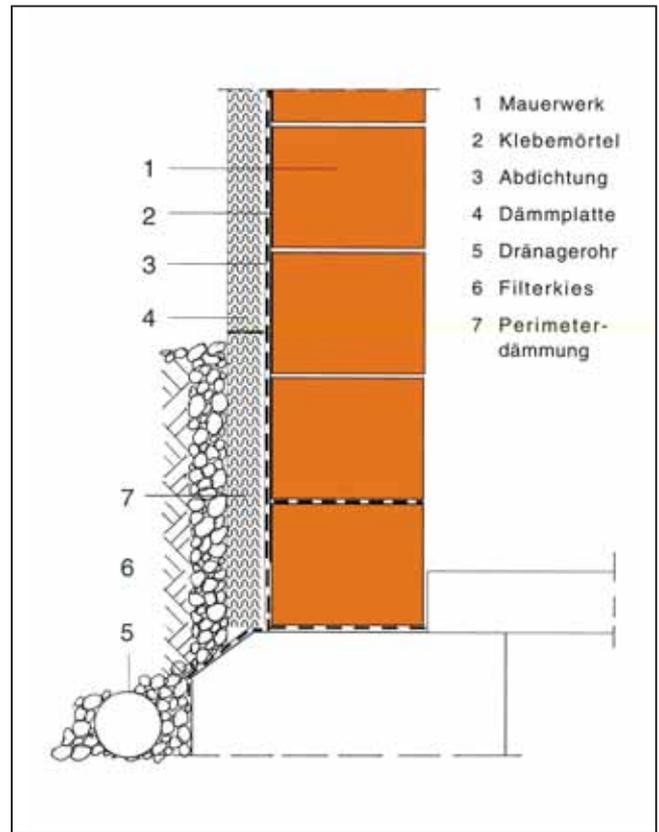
Dämmung im Erdreich – Schnitt Fundament aufsteigendes Mauerwerk
